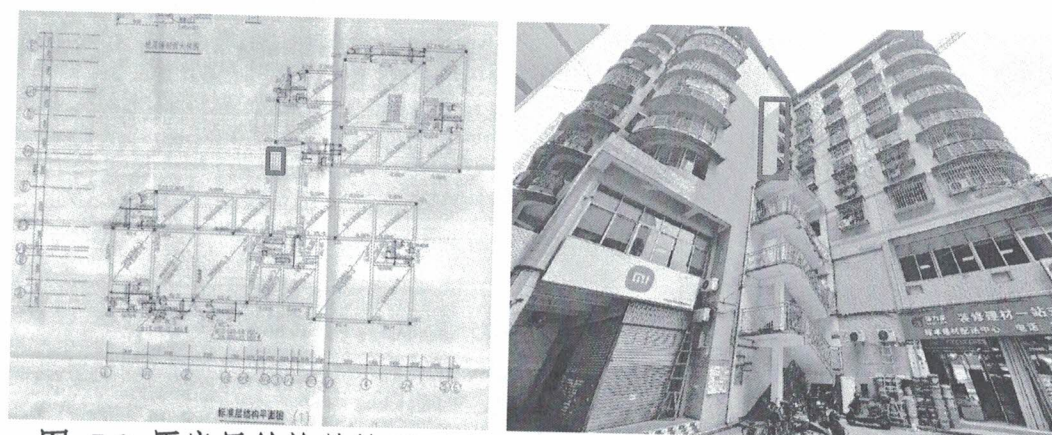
原房屋结构结构平面布置图（红色方框为开门洞位置示意）
